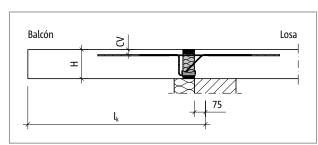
Schöck Isokorb® T tipo K-M1 hasta M11: Sistema estático
